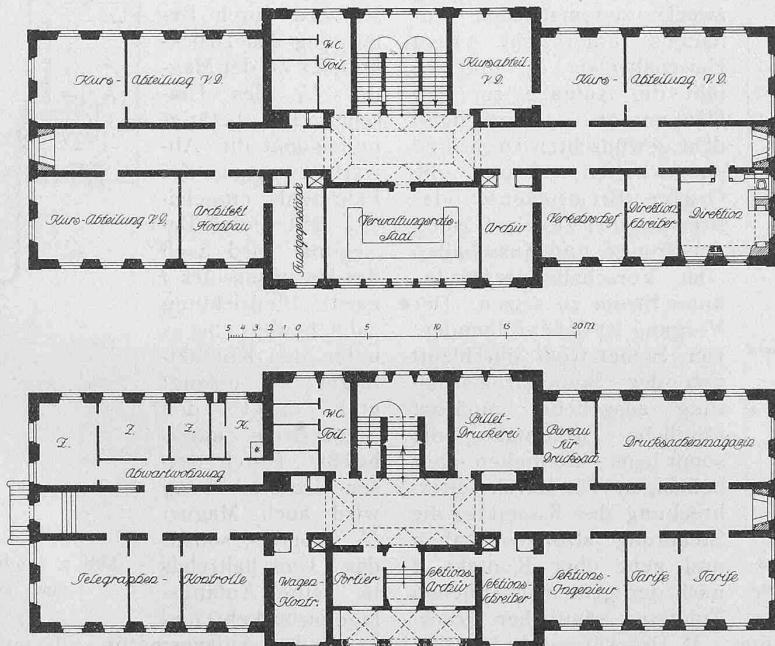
und 3. Grundrisse vom Erdgeschoss und I. Stock. — Maßstab 1:500.
